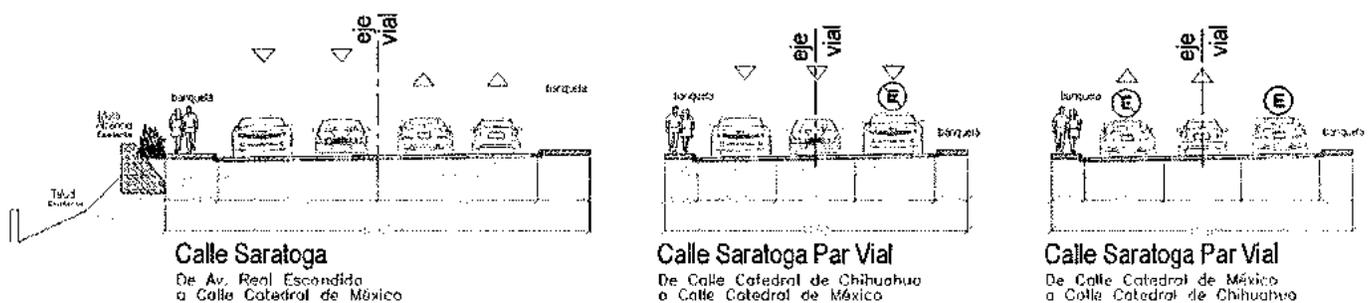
Sección de vialidad Calle Saratoga Propuesta
